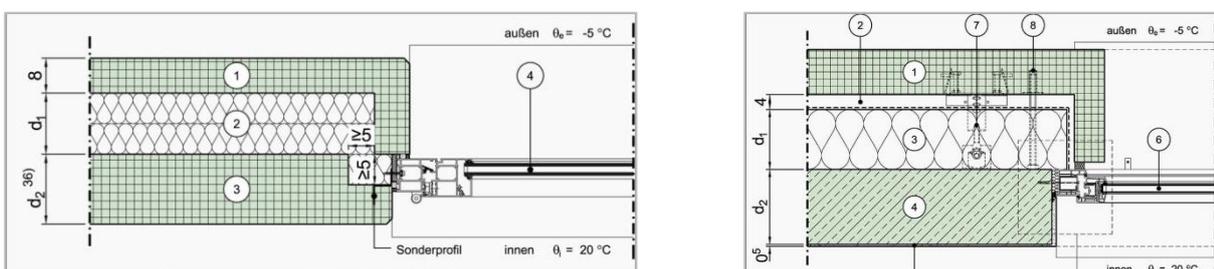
Beispiele aus dem Planungsatlas für den Hochbau für Sandwich- und Vorgehängte Fassade
